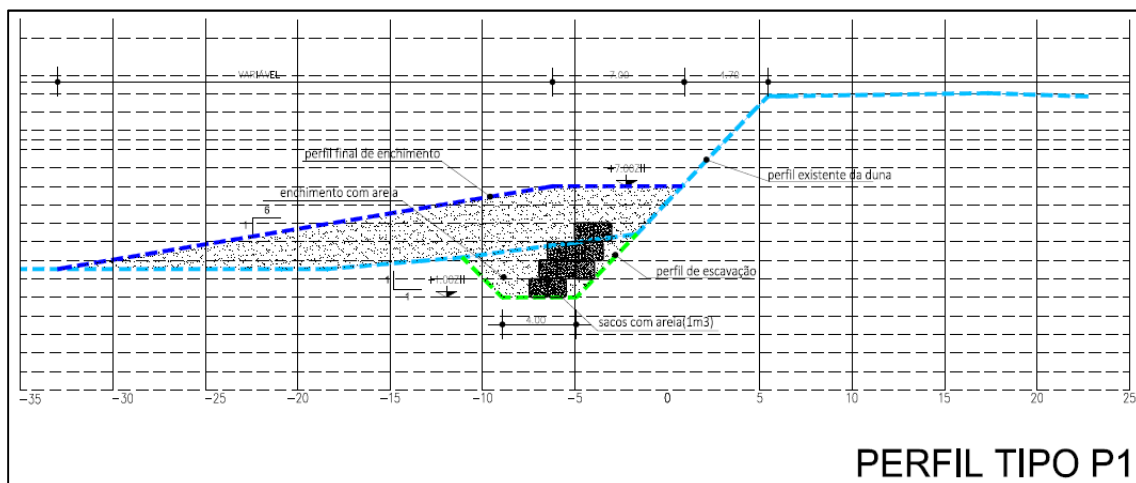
Troço do Casal Ventoso – Perfil tipo (fonte: APA, fevereiro de 2014)
